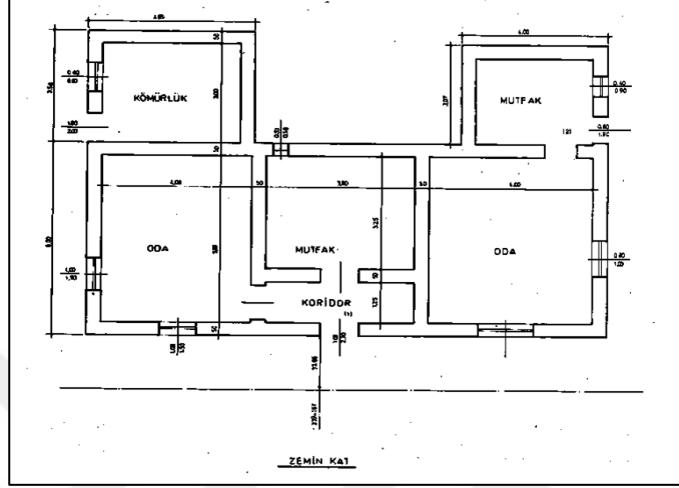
Bekçi Evine Ait Plan (TCDD).
